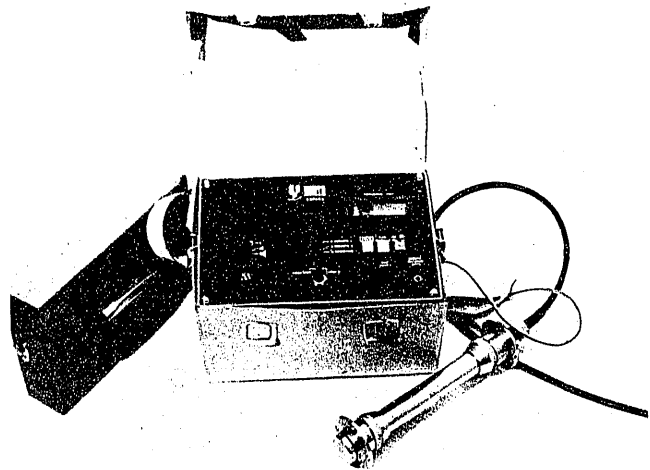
Extensómetros de cuerda vibrante a colocar en el hormigón en masa y aparato de lectura.
